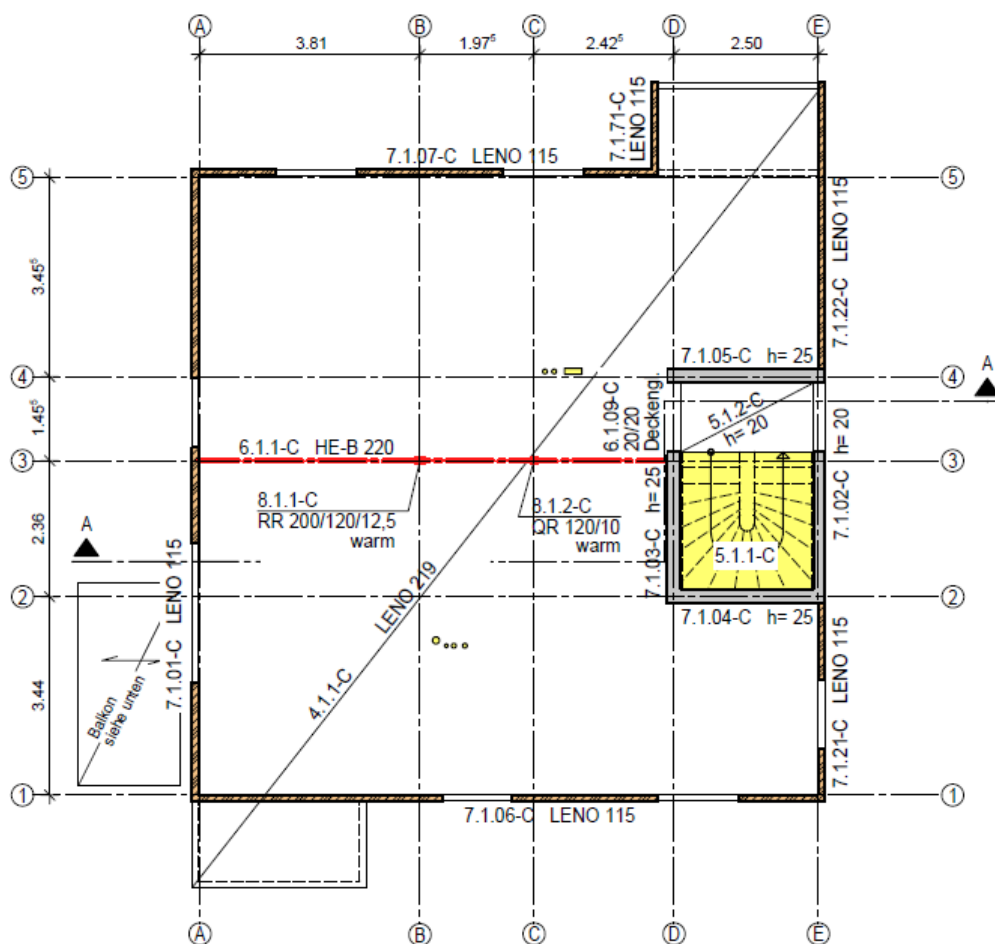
Positionplan des 1. Obergeschosses, Haus C
